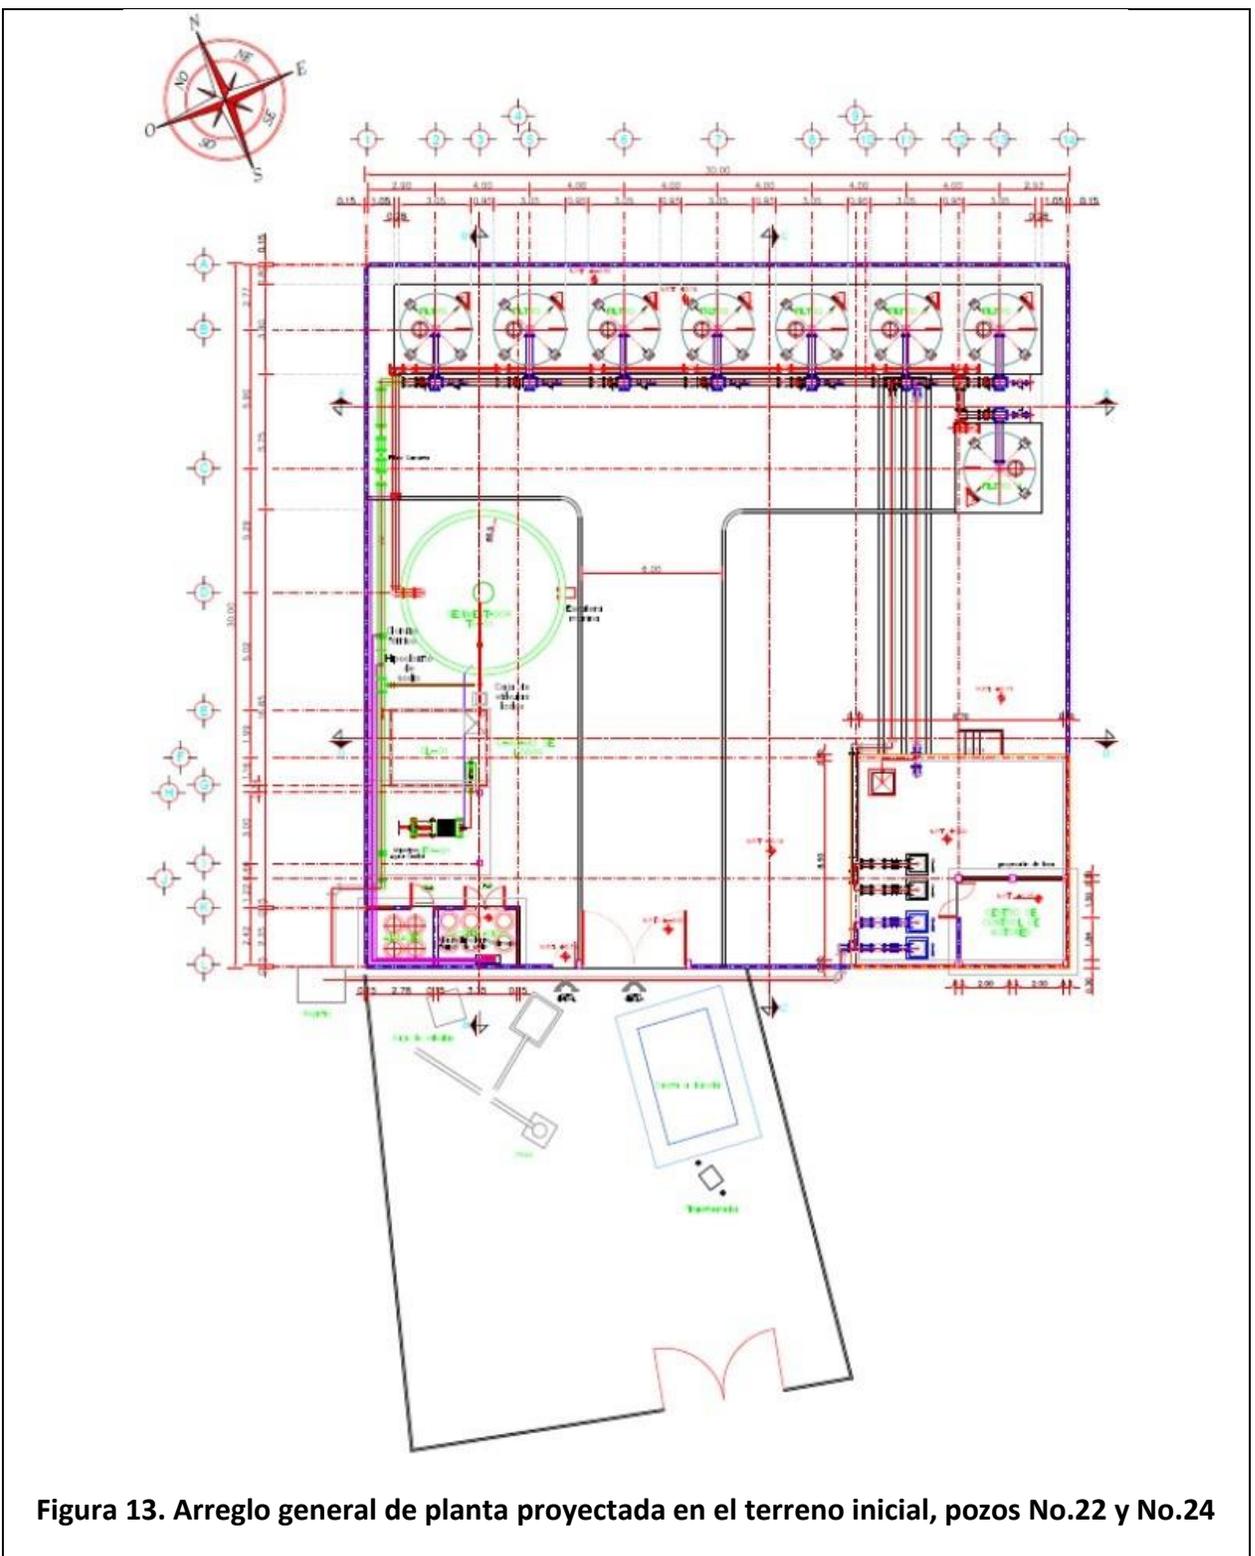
Arreglo general de planta proyectada en el terreno inicial, pozos No.22 y No.24
